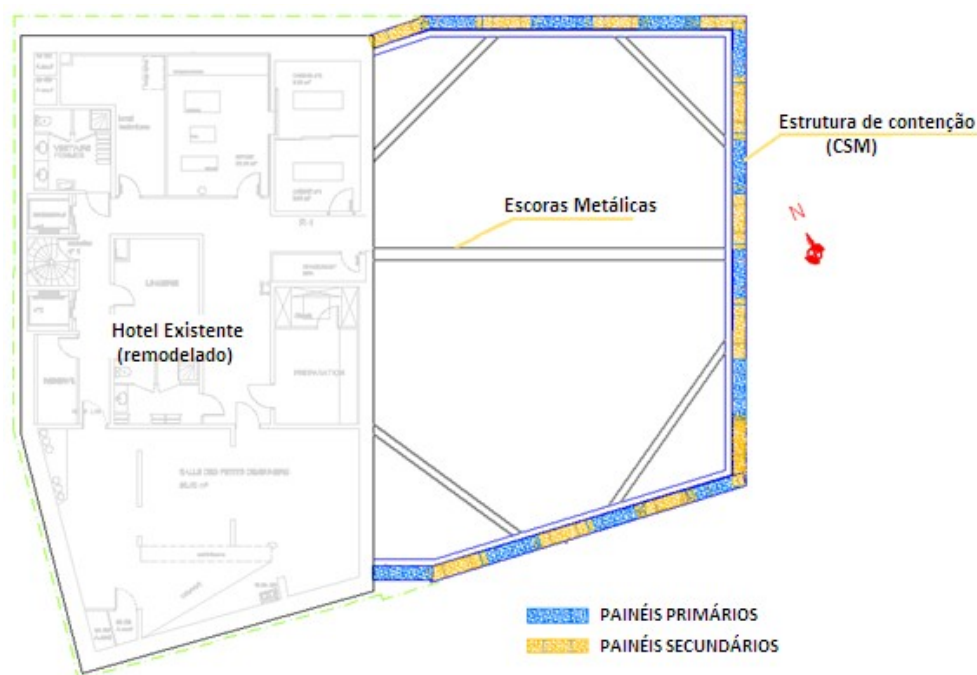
Planta da Estrutura de Contenção e do Escoramento Horizontal
